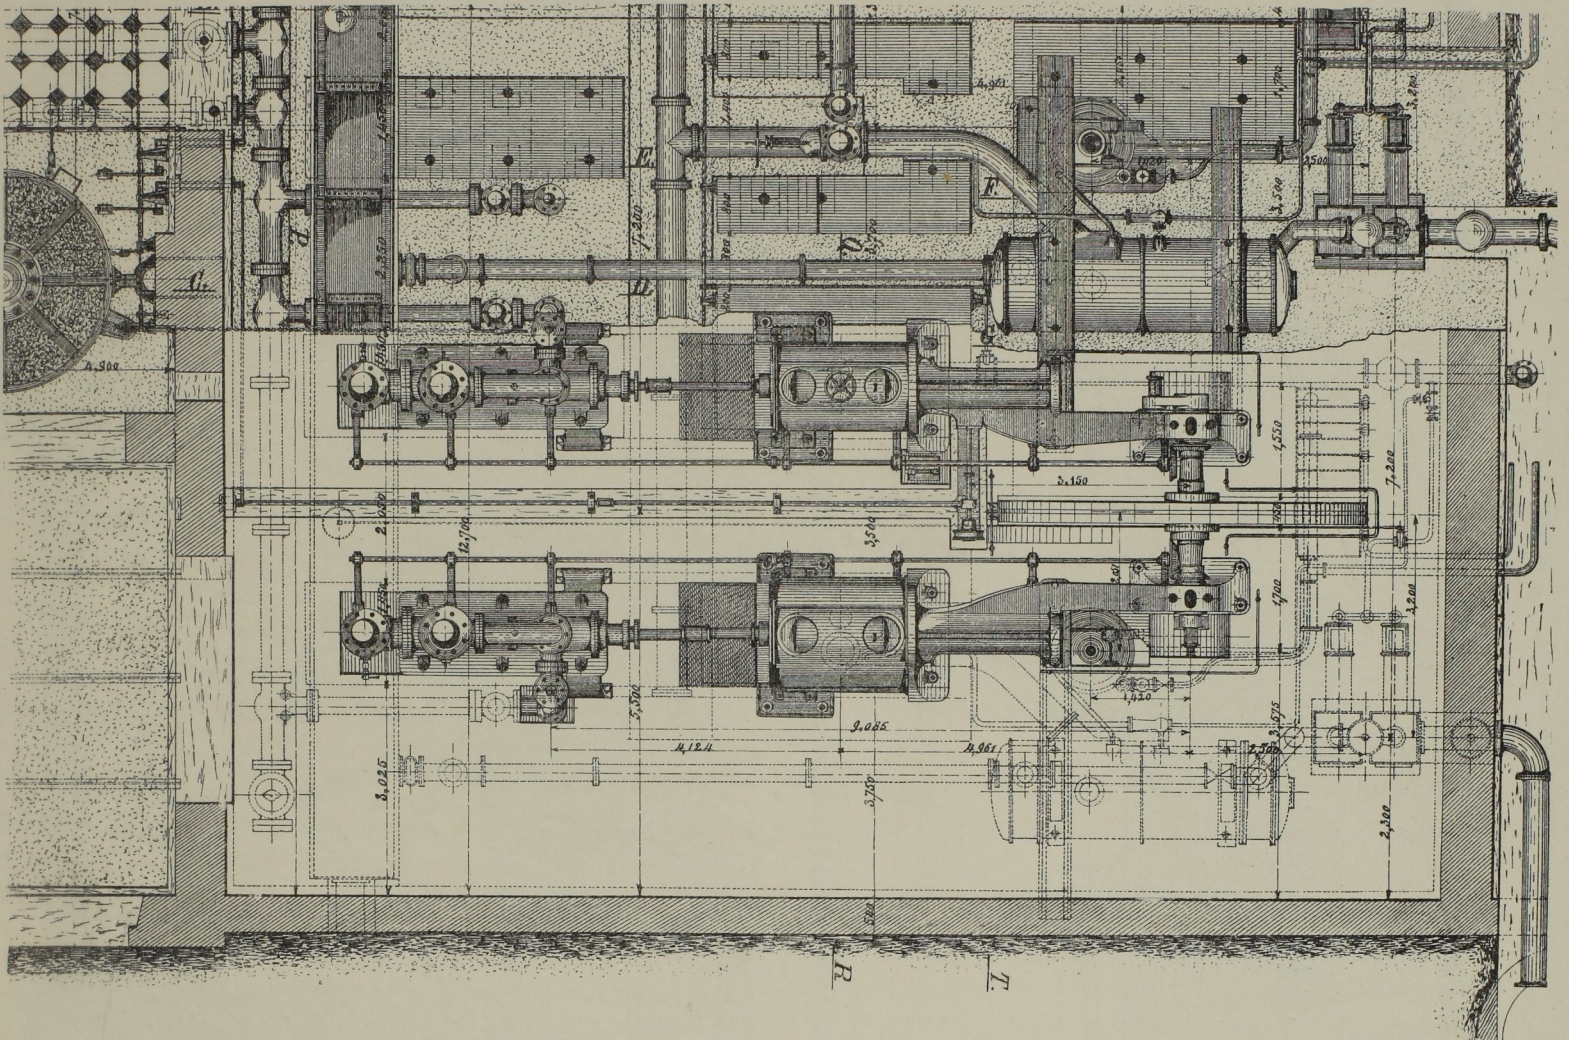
Grundriss der Pumpenanlage. Massst. 1:100.
